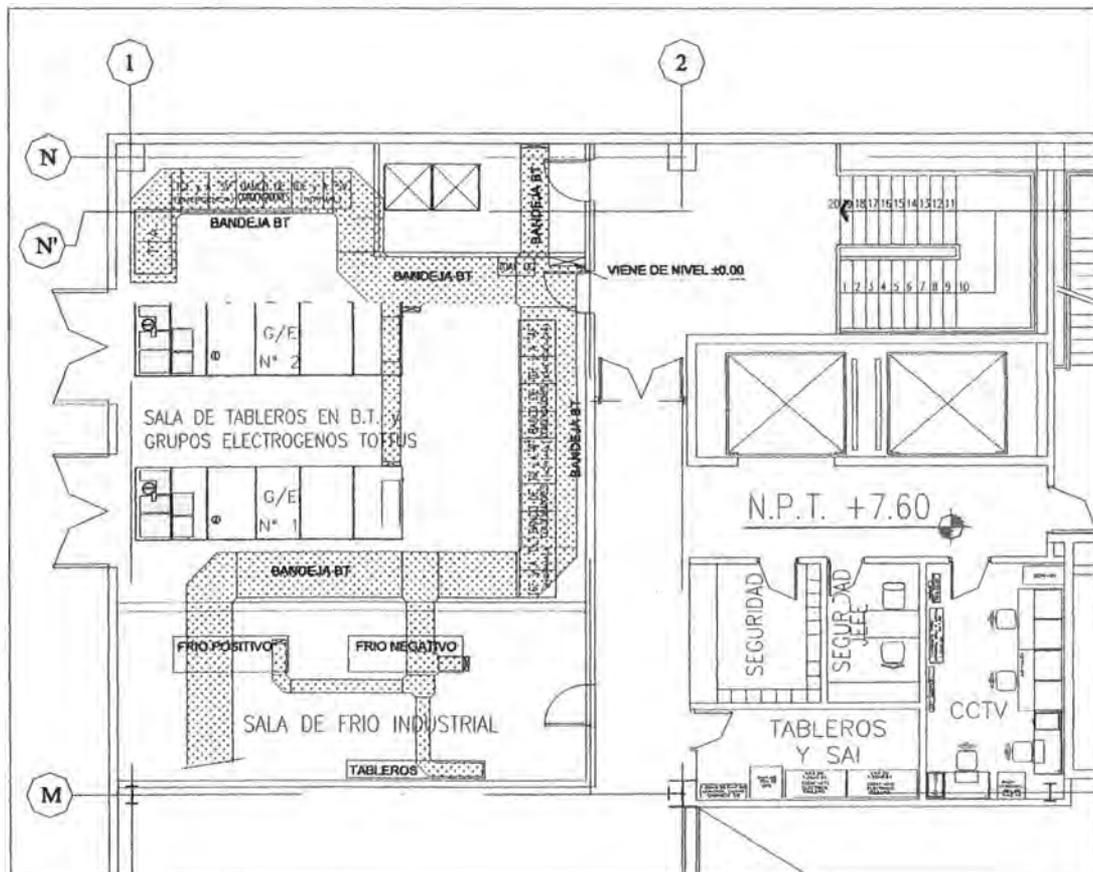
, Vista de planta del cuarto técnico, nivel +7.60.
